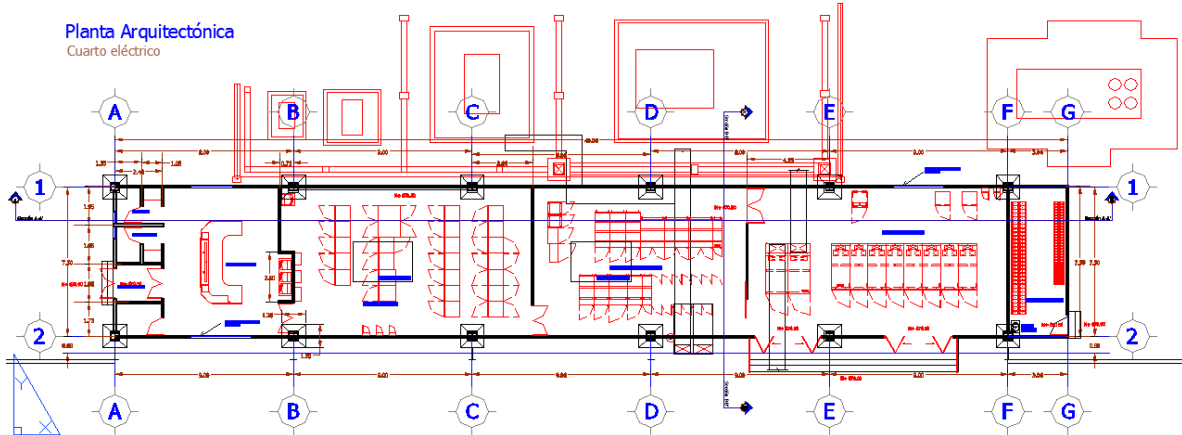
Arreglo arquitectónico de edificio eléctrico (Vista en planta)
